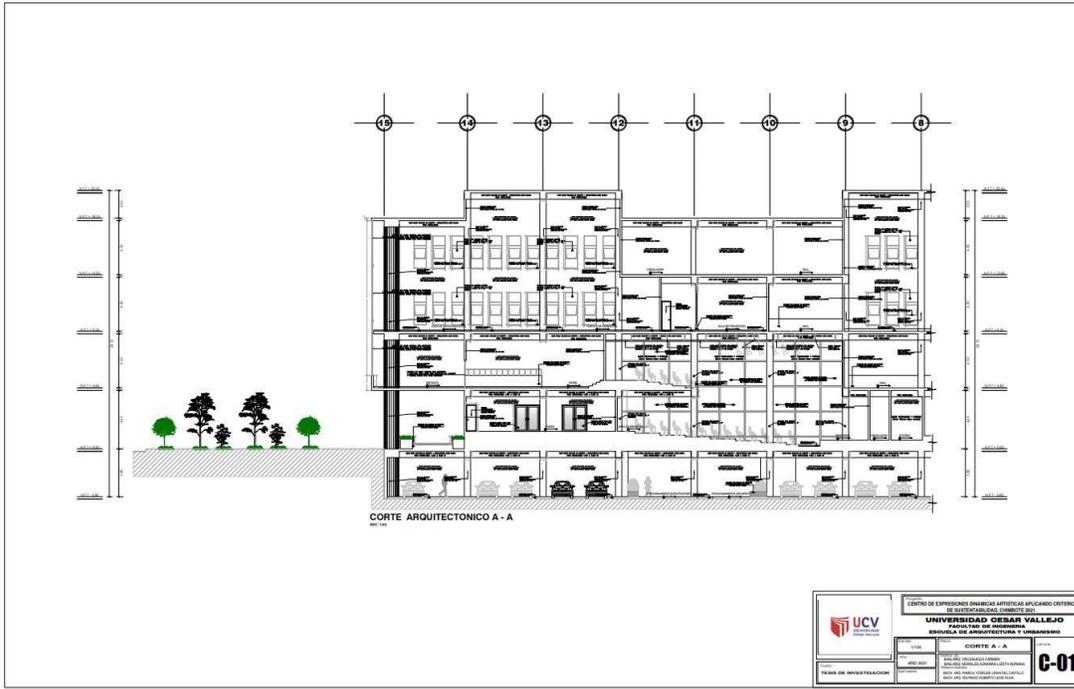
Plano de Corte A-A Detalles. Fuente: Elaboración Propia
